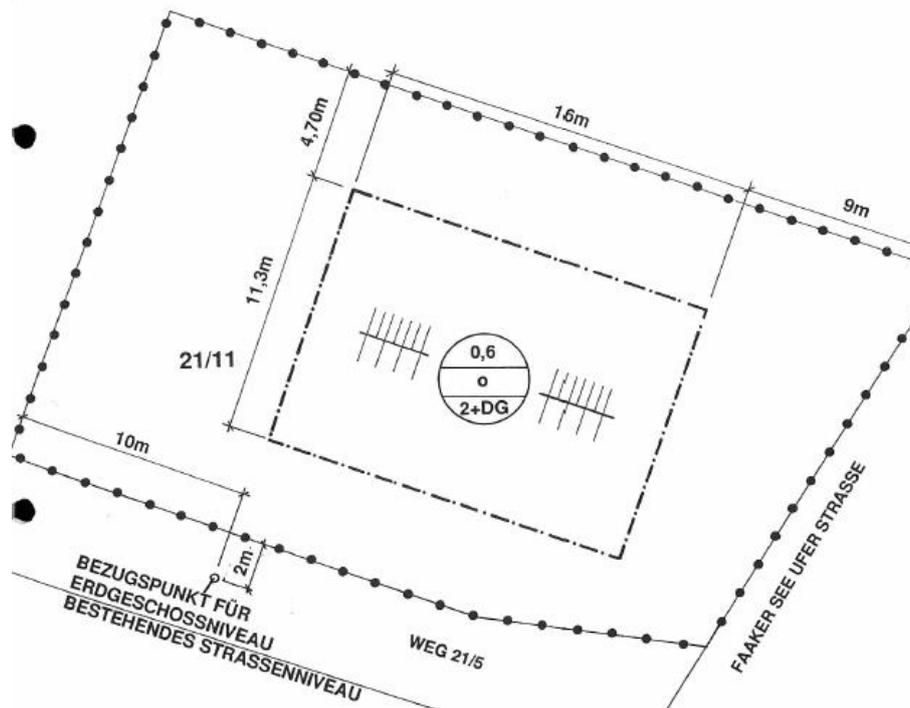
Rechtsplan mit Bebauungsbedingungen „Köll-Grund“ (Parz. Nr. 21/11, KG Latschach (Quelle: KAGIS))
